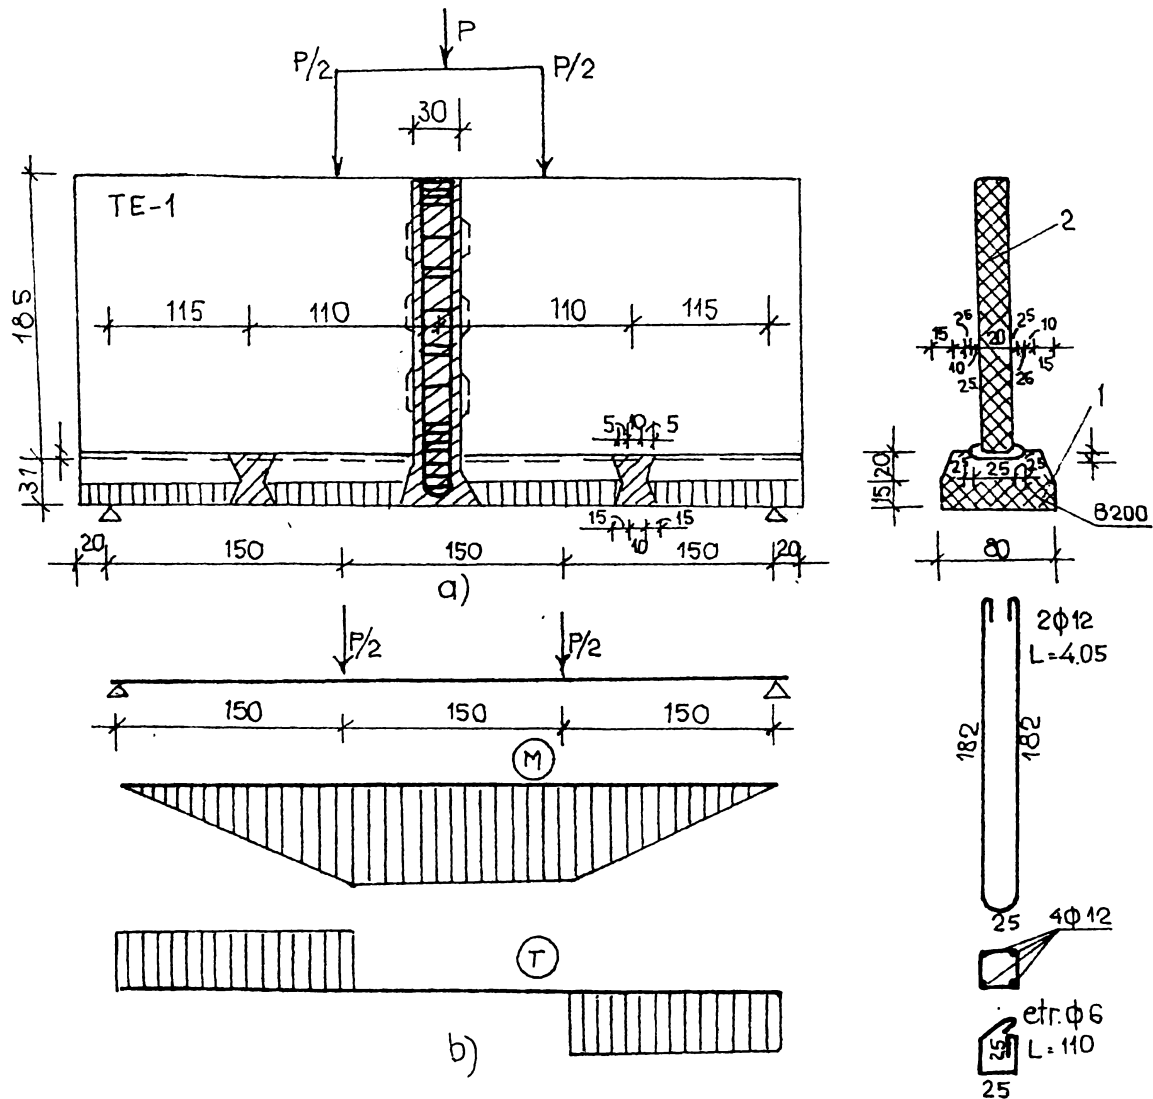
Elementul TE₁. Schemă statică: a-alcătuirea elementului; b-schemă statică; 1-talpa; 2-alevația.
